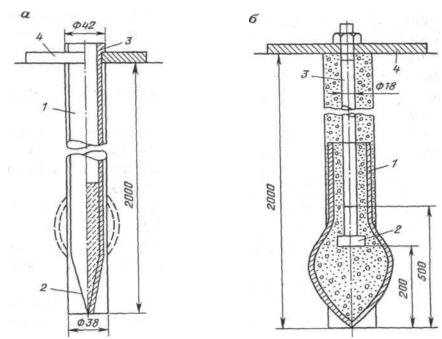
Конструкции взрывораспорного (a) и железобетонного трубчато-болтового (б) анкеров
